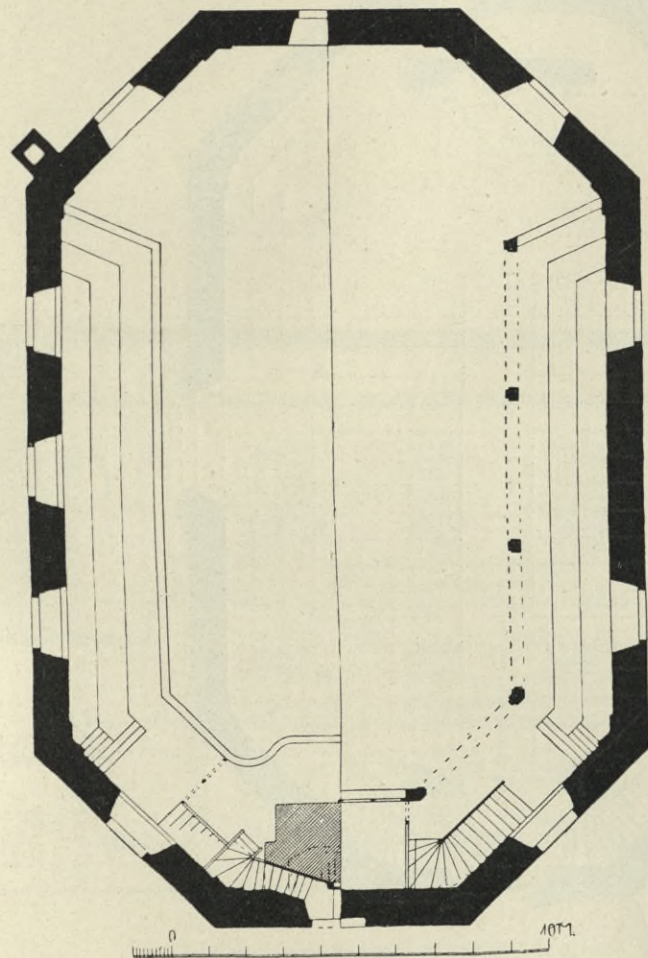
Loschwitz, Grundriss der Kirche.
